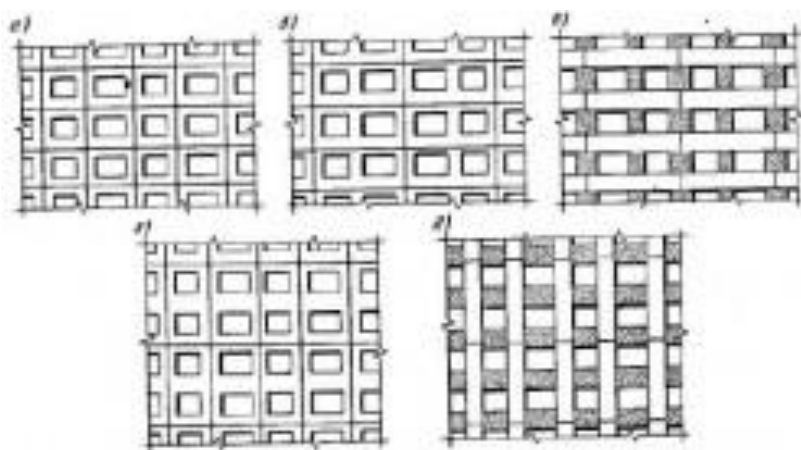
Схемы разрезки наружных стен на панели: а - горизонтальная на одну комнату, б - то же, на две комнаты, в - то же, полосовая, г вертикальная, д — то же, полосовая
